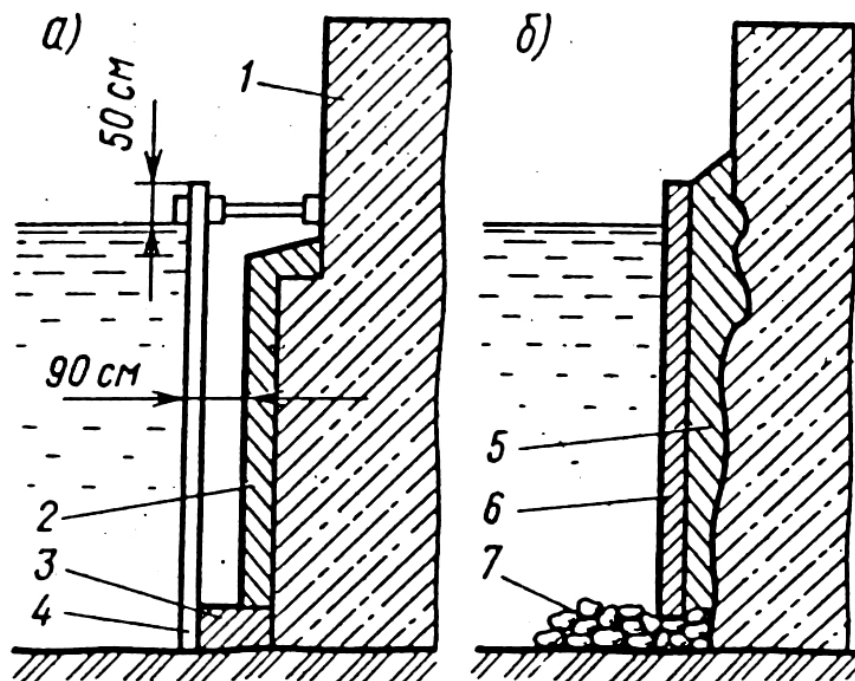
Схема устройства защитной железобетонной оболочки для подводной части опоры: а – с применением шпунта и откачкой воды; б – с применением бетонного ящика без откачки воды; 1 – кладка опоры; 2 – железобетонная оболочка; 3 – тампон из подводного бетона; 4 – шпунтовая перемычка; 5 – бетон заполнения пазух подводным способом; 6 – железобетонная оболочка ограждения; 7 – каменная отсыпка
